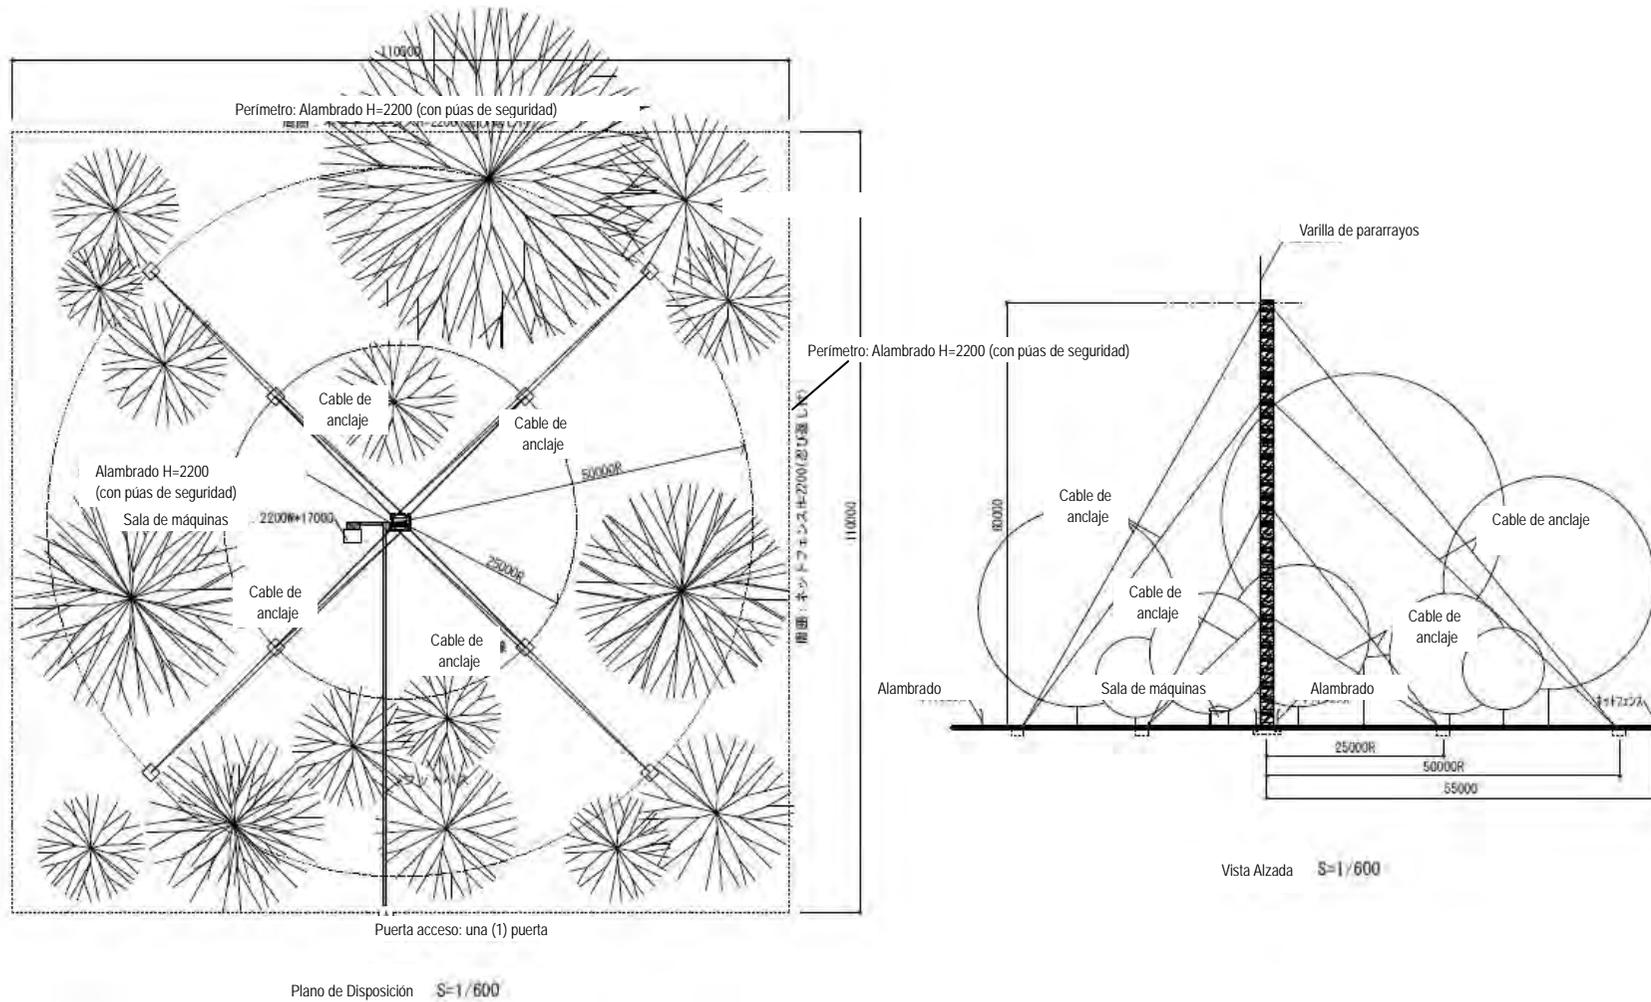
Plano de Disposición y Vista Alzada de la Torre (h=60m) (plano referencial)
